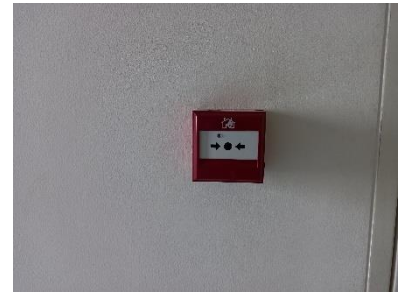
ระบบไฟฟ้าภายในโครงการ
